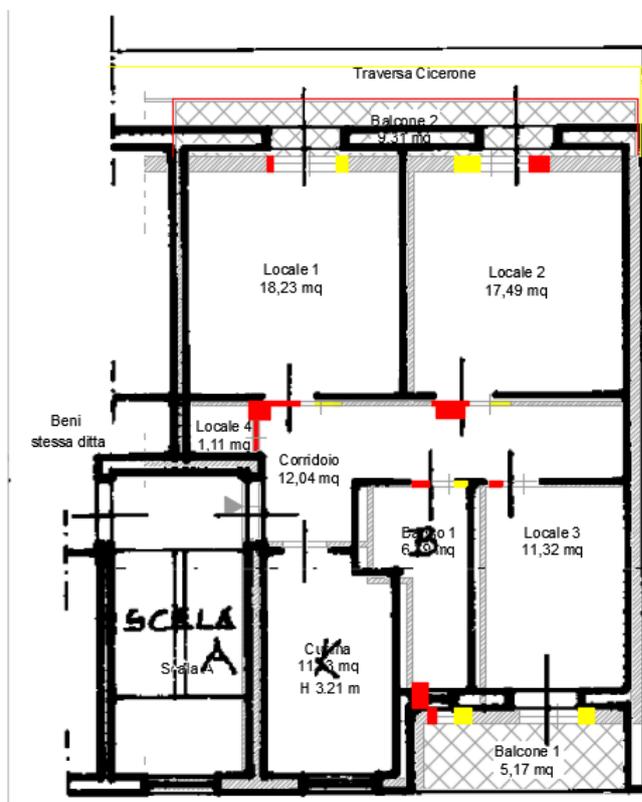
Confronto con planimetria catastale (Foglio 4, p.lla 1225, sub. 4)
